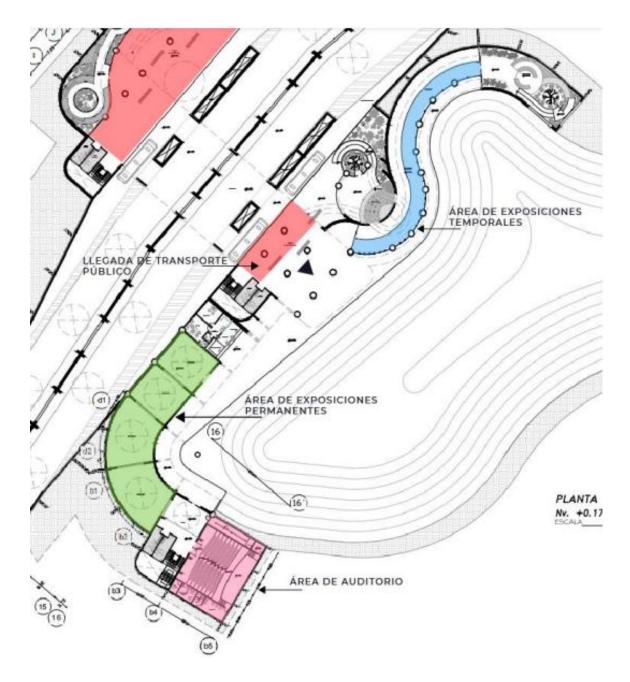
Planta baja, áreas culturales y llegada de transporte público
